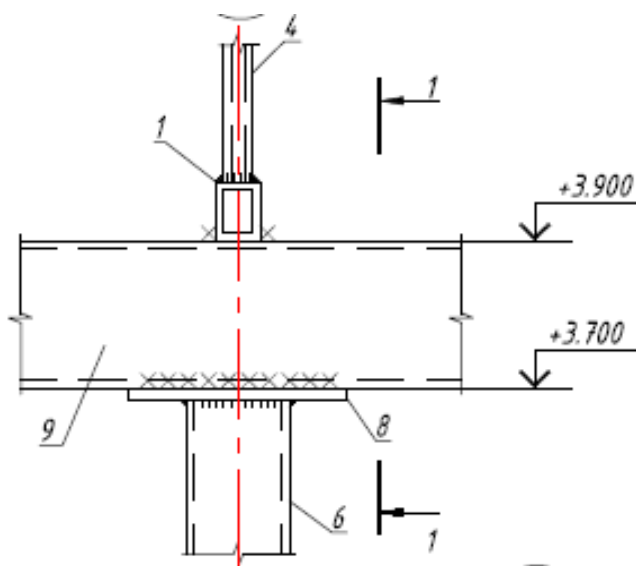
Запропоноване конструктивне вирішення вузла опирання нижнього поясу крокв'яної ферми на вертикальну стійку (вид спереду).
